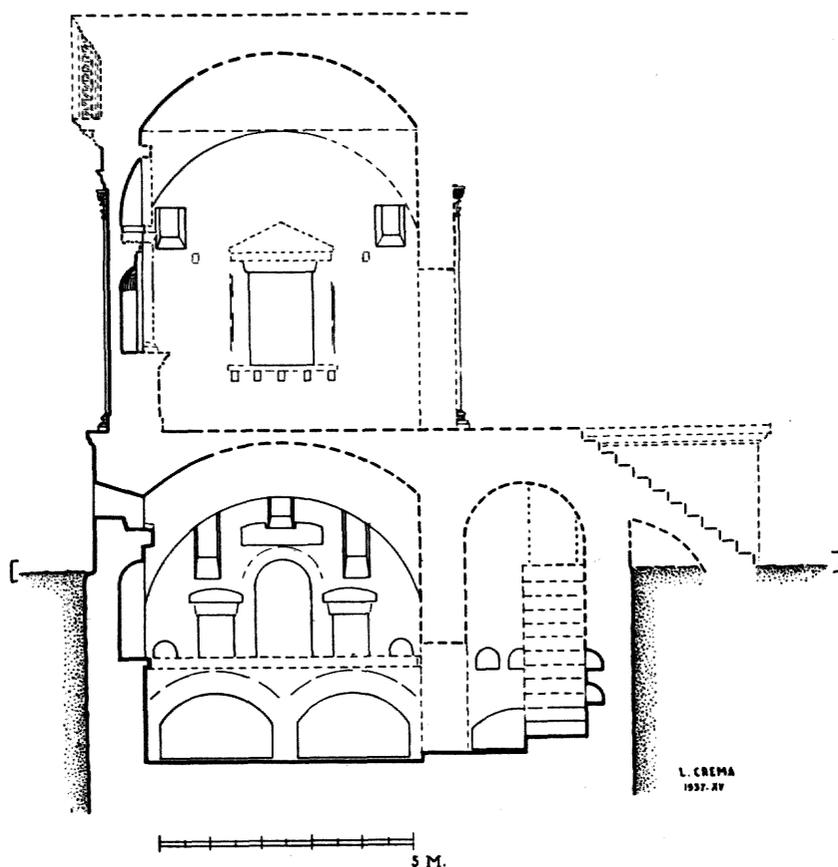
Sepolcro detto la Sedia del Diavolo. Sezione longitudinale.
